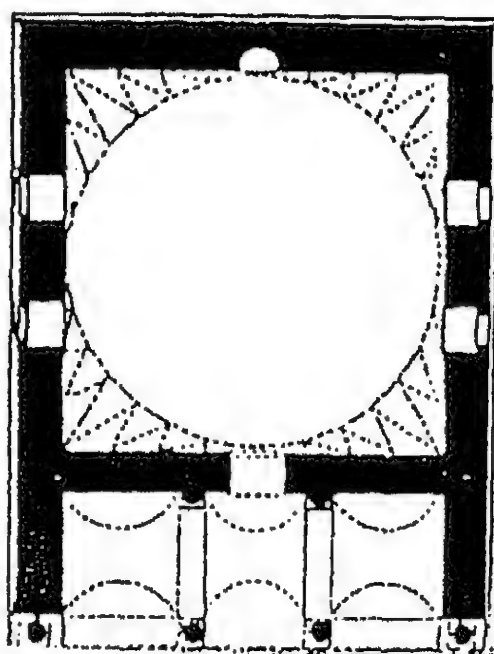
مسقط أفقي لمسجد حسن بالي زاده في الباسان (عن : كيل) .
